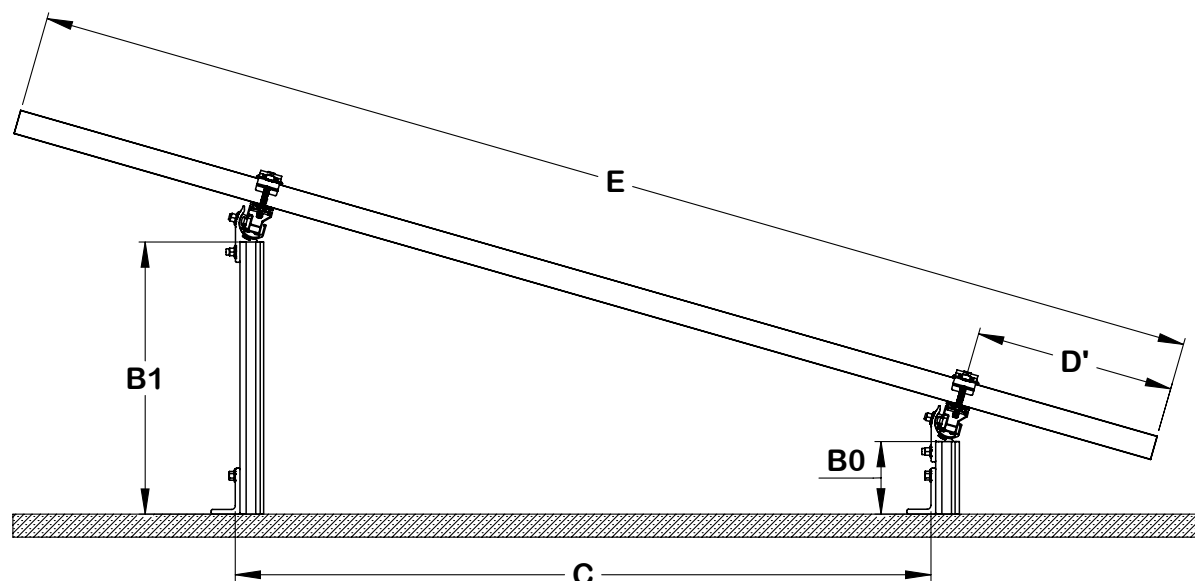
Dimensiones de ensamble para sistema Simple Tilt..
